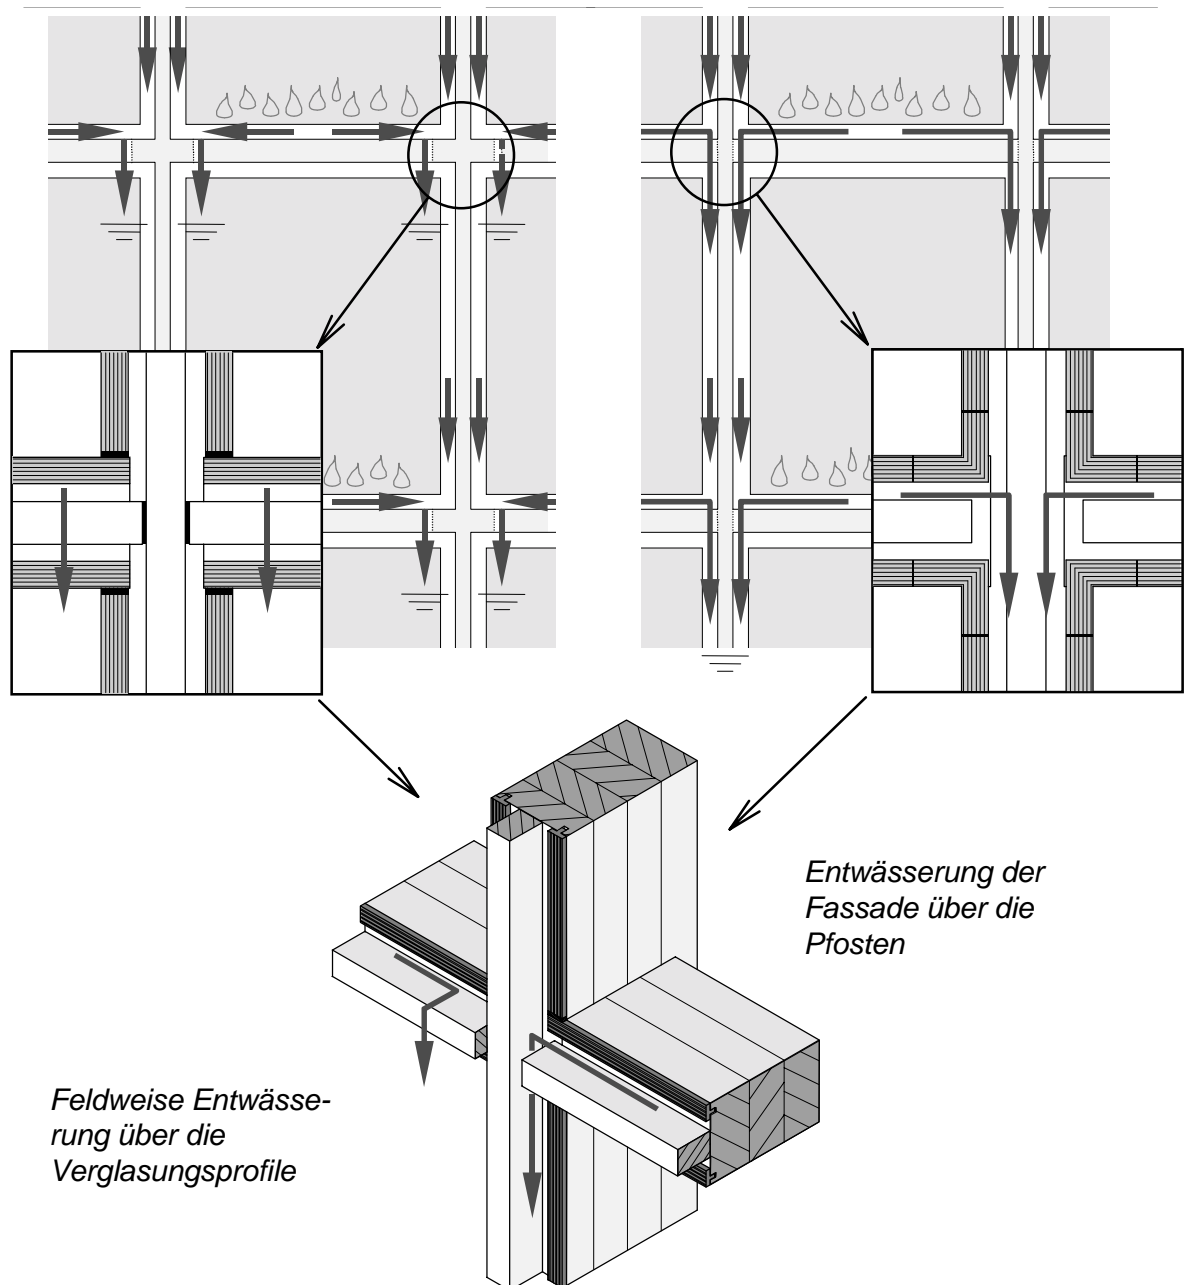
Entwässerungsmöglichkeiten einer Fassadenkonstruktion
